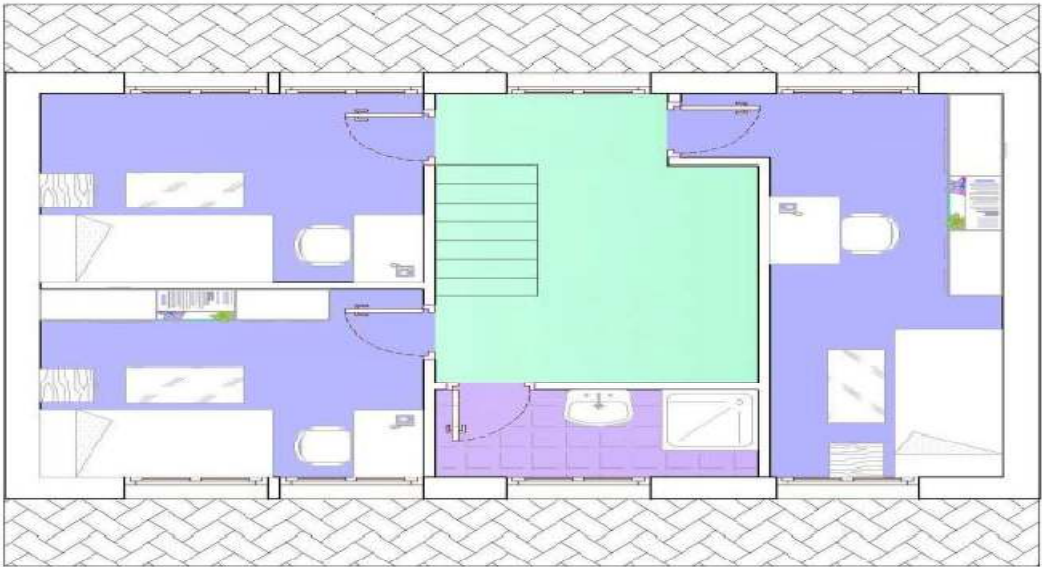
plan du 1er étage réalisé avec Autocad.
